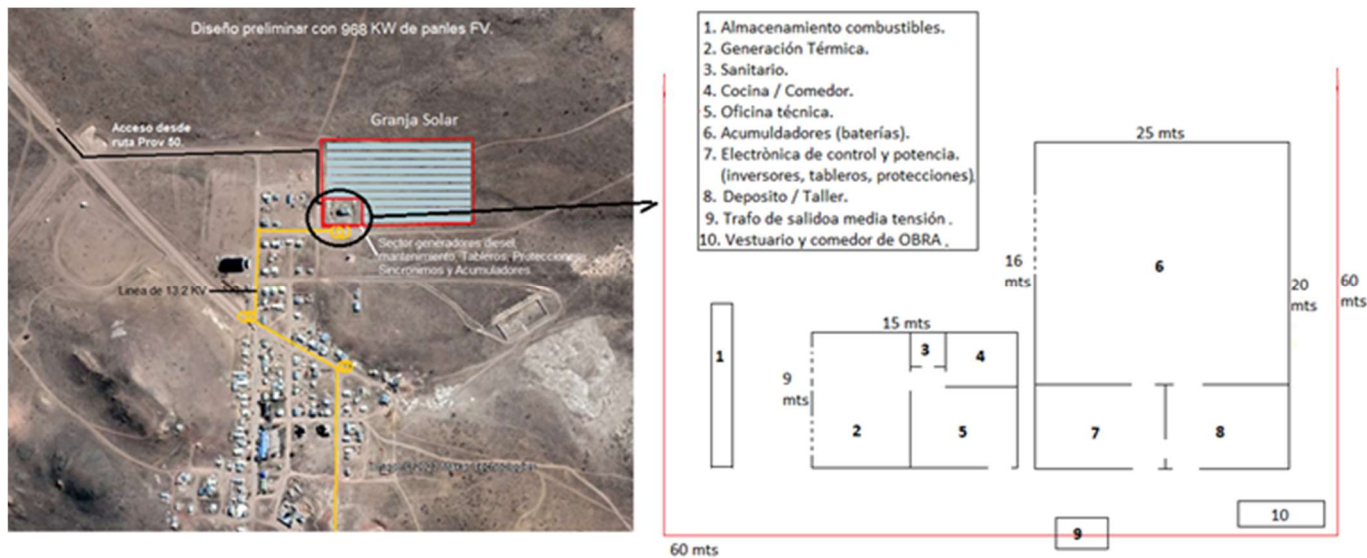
Croquis general del proyecto sujeto a plano final. Fuente: elaborado por responsable técnico del proyecto.
